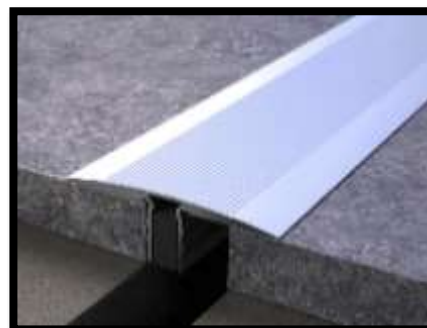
Couvre joint en aluminium pour l'ensemble du projet
